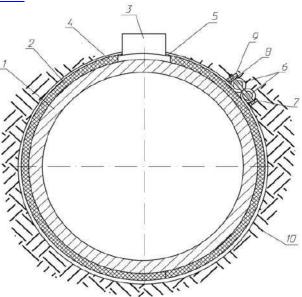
Схема установки и крепления ППТП с корпусом типа «К1» на трубопроводе 1 – труба, 2 – изоляция трубы, 3 – корпус ППТП, 4 – хомутная лента, 5 – электроизоляционные вкладыши, 6 – стержни с отверстиями, 7 – болт, 8 – шайба, 9 – гайка, 10 – грунт
